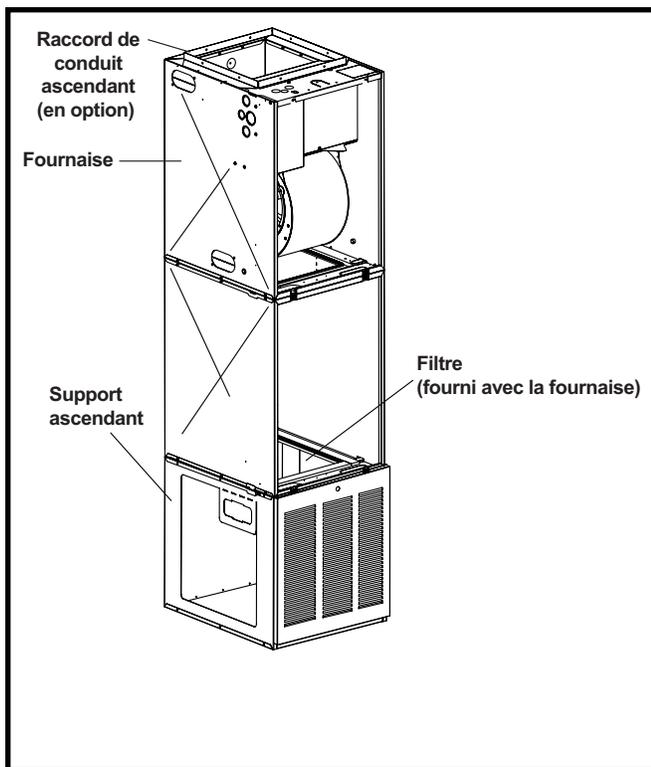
Système d'air de reprise à travers le plancher avec support ascendant
